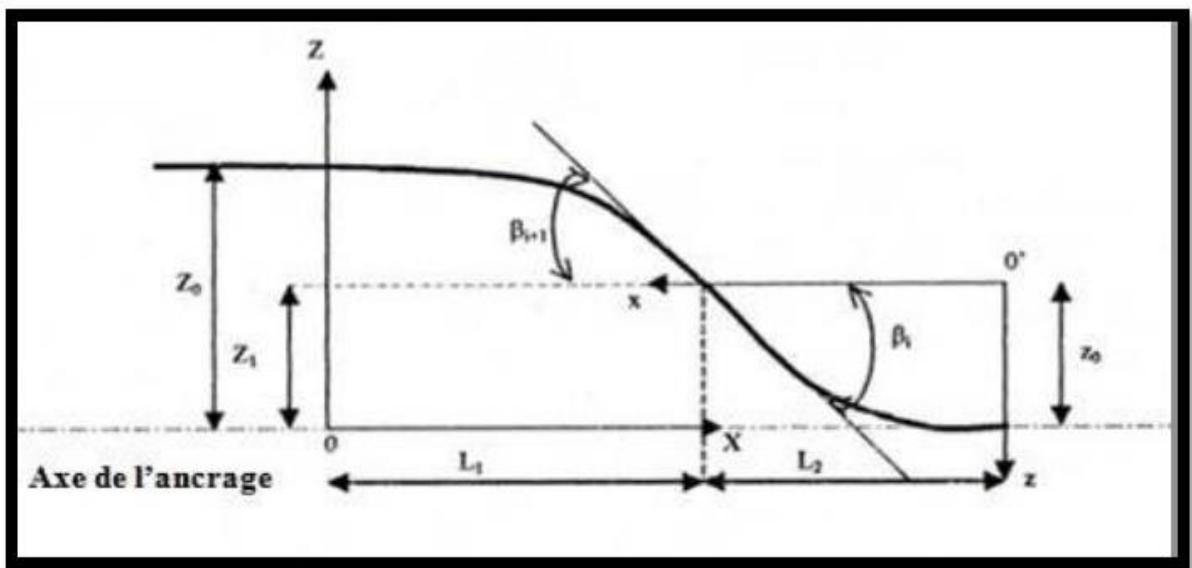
Tracé en plan d'un câble de fléau.
